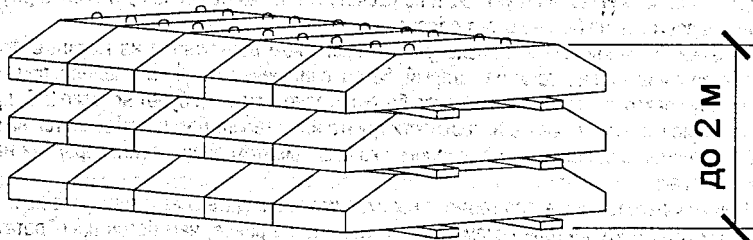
Схема складирования фундаментных плит в штабеле
